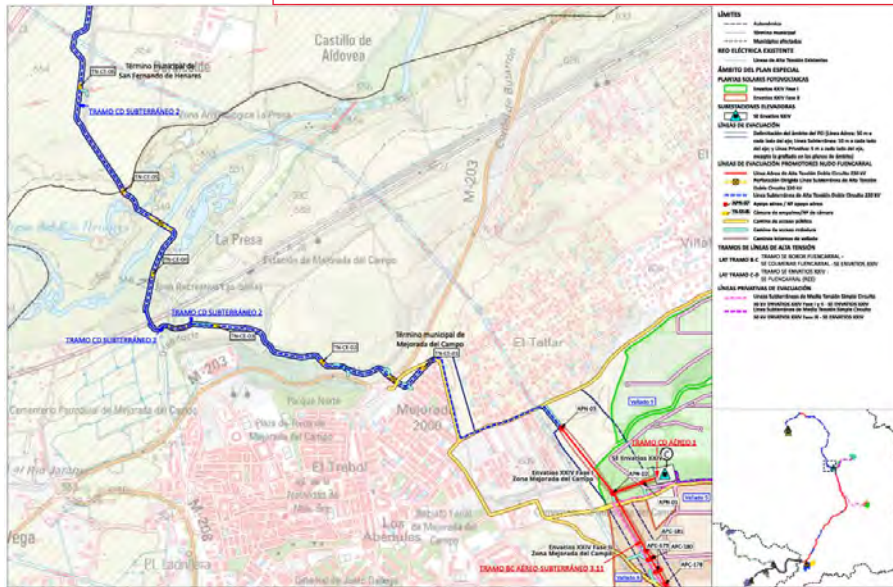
Plano de Ordenación O2.5.1. Planta por tramos. LASAT Promotores Nudo Fuencarral Tramo C-D
